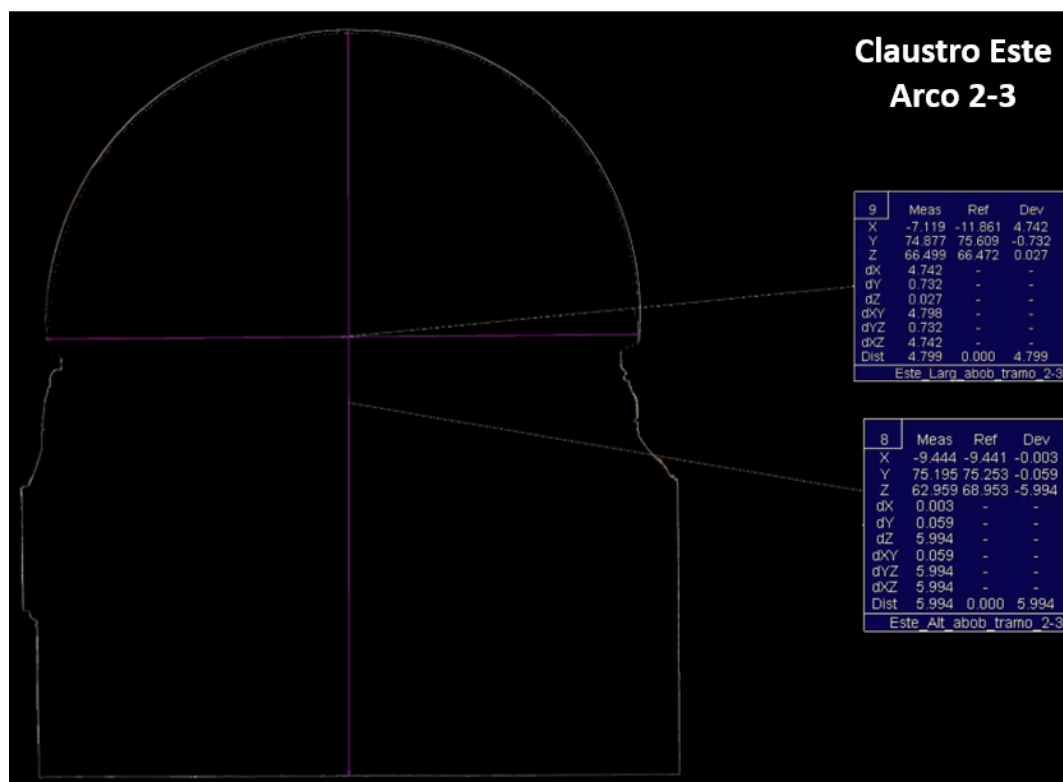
Corte transversal do Arco 2-3 do claustro Este de D. Dinis.
